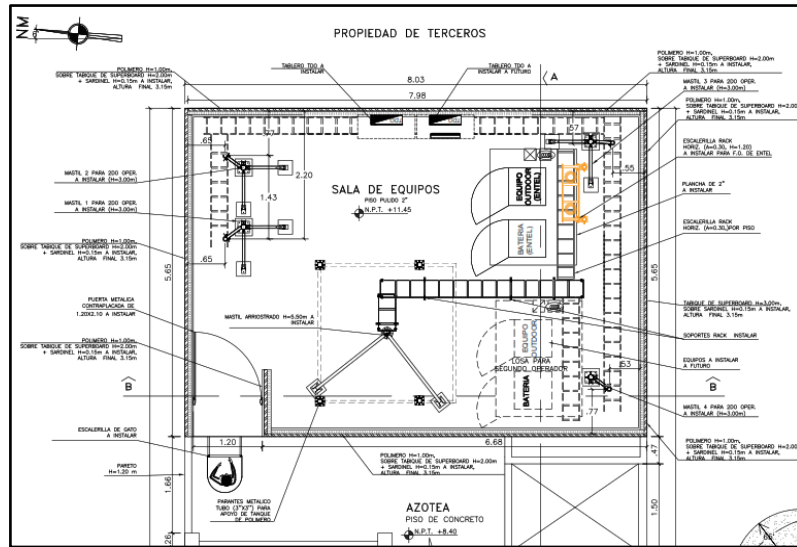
Plano de Planta Model Estación Base Celular Tipo Rooftop
